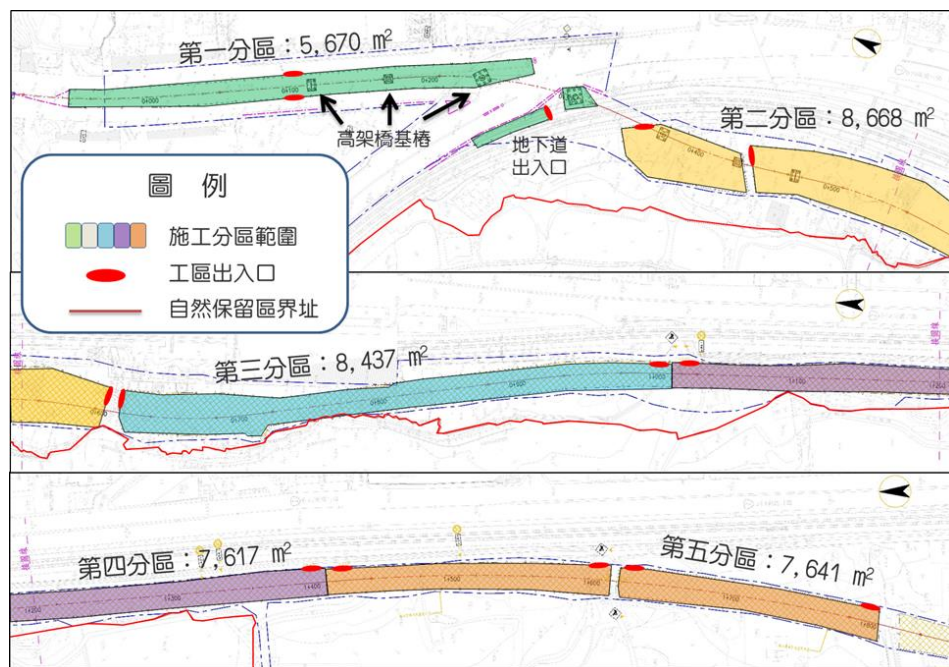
計畫道路紅樹林濕地上游路段施工分區設施平面配置示意
